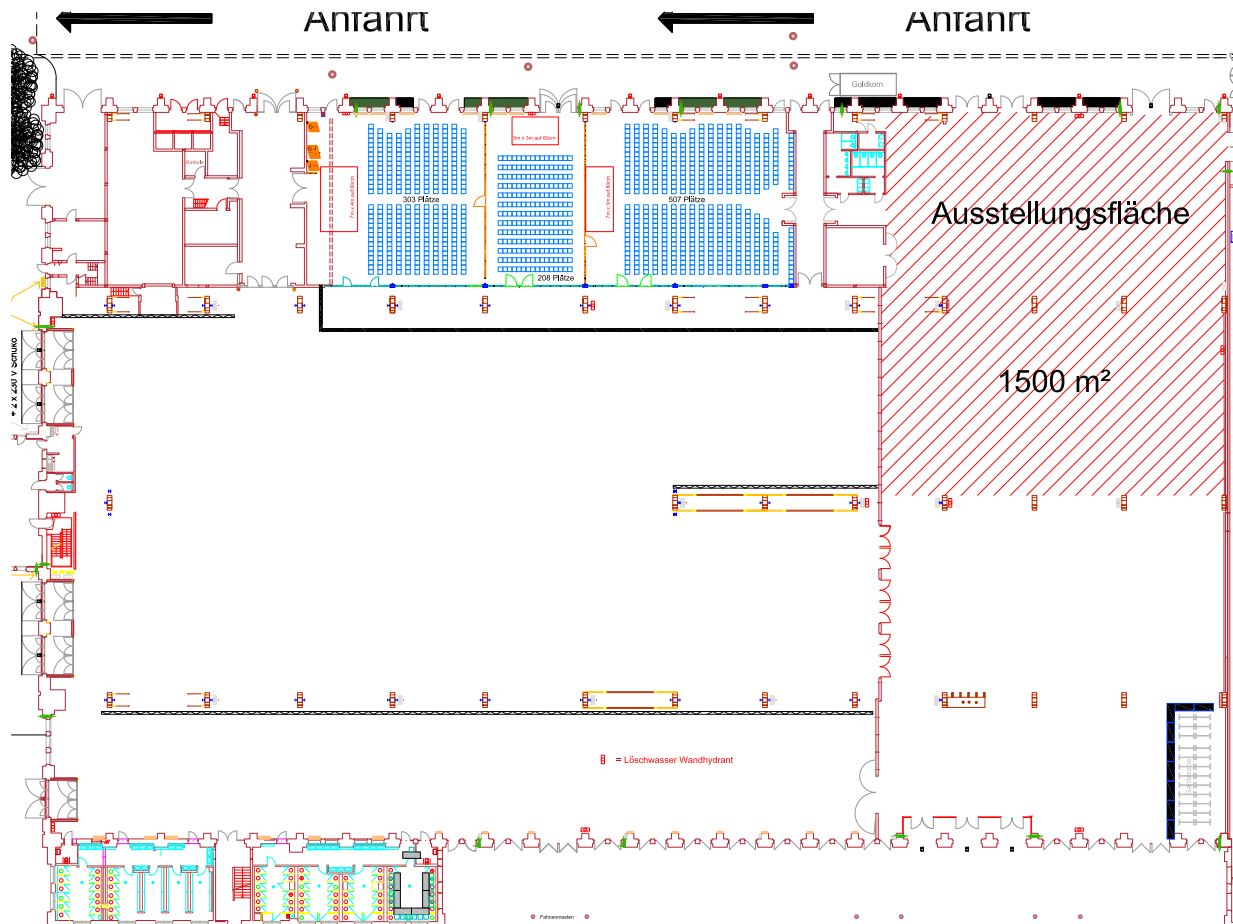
links: Halle 3 mit Bsp. Workshopräumen und Ausstellungsfläche in Halle 2
